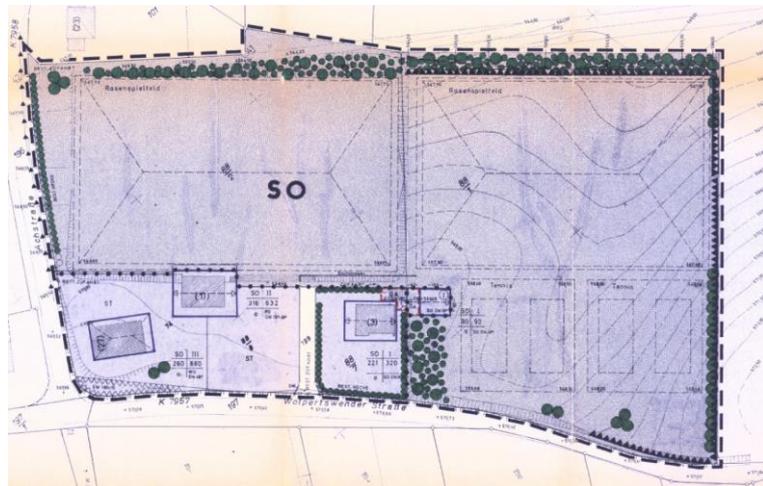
Bebauungsplan „Langwegesch“ 1984
